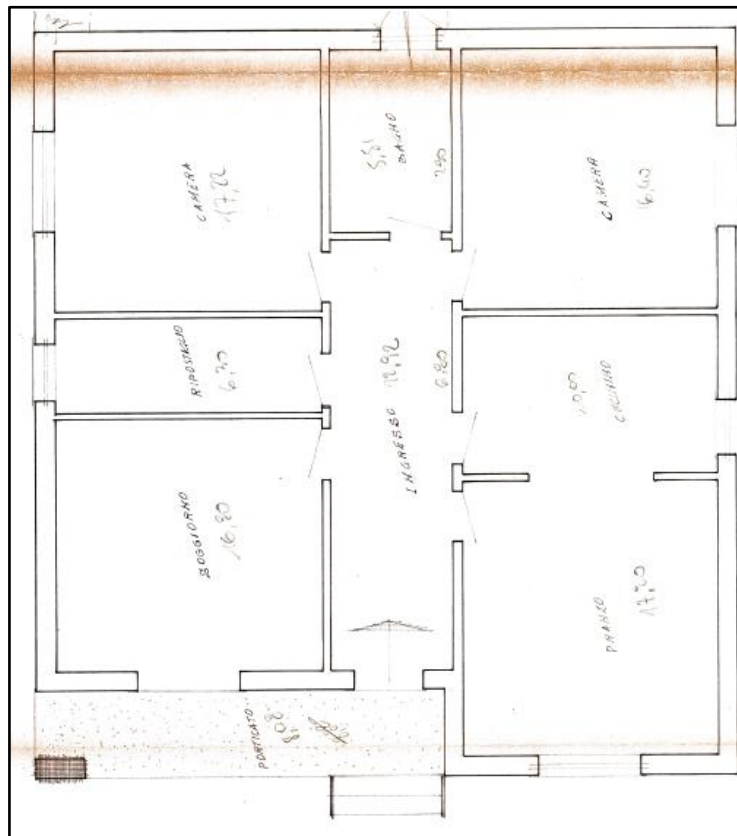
Pianta (piano terra) del fabbricato licenziato nel 1974
